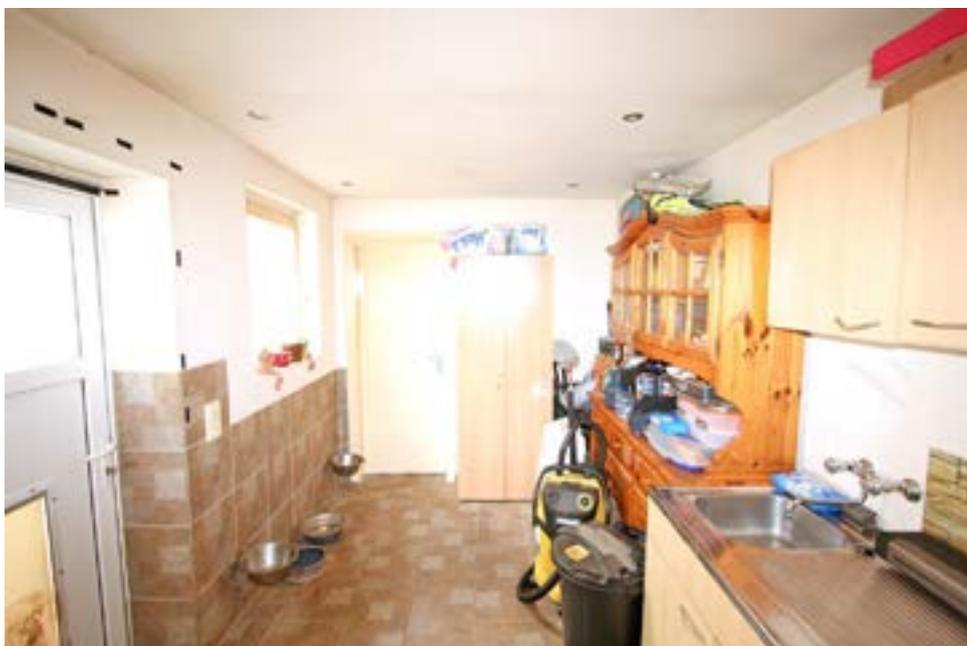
Zur Werkstatt gehörender WC-Vorraum im eingeschossigen Anbau
